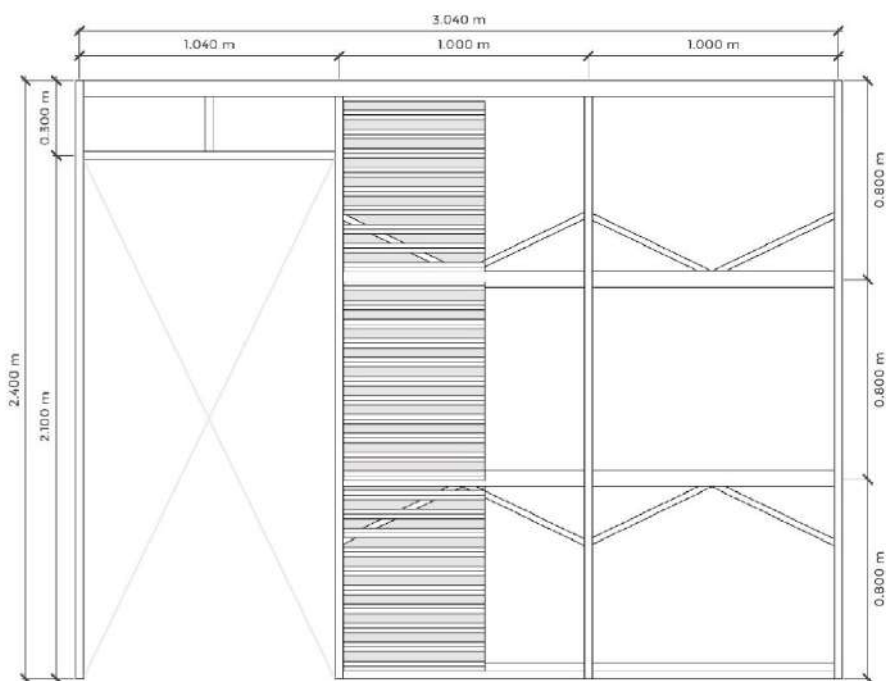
Propuesta para estructura de quinchas con vano de puerta. Opción 2. [Realizado por autor]
